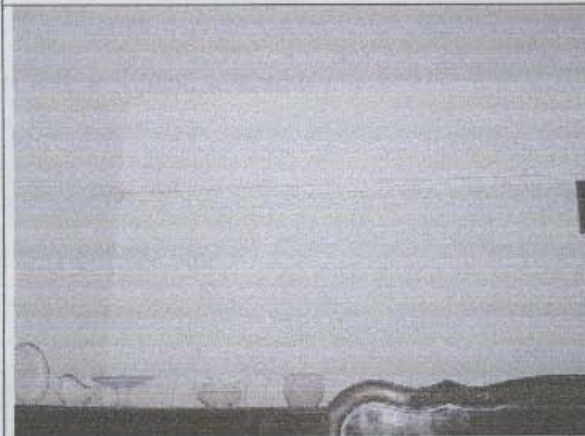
Vista interna del primer piso sin daño estructural aparente.
